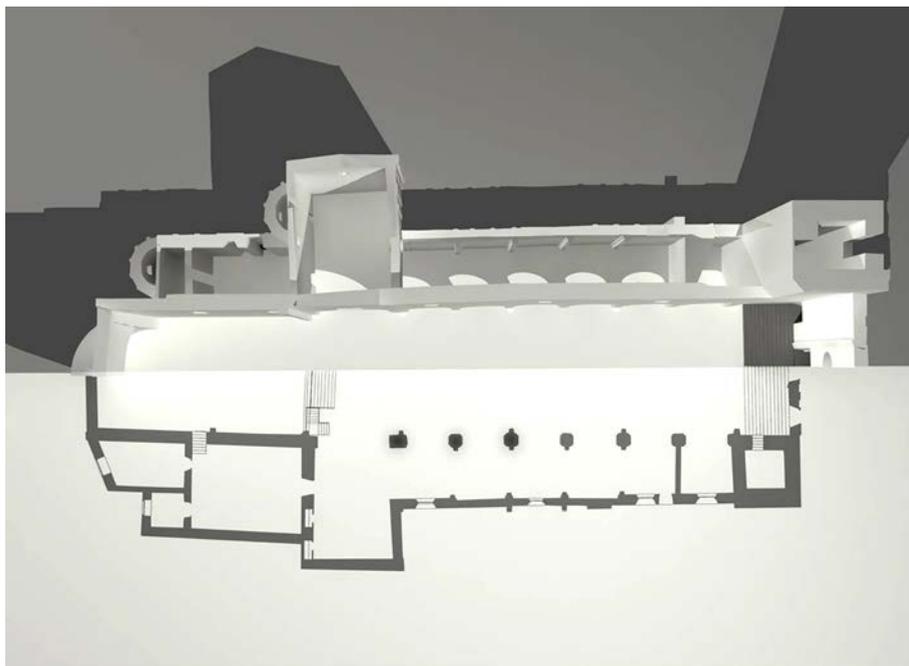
Bobbio. Chiesa cattedrale di Santa Maria. Planimetria e restituzione dell'elevato sud. Rilievo di Carlo Bergamaschi, Davide Griffini, Andrea Vaccari.
